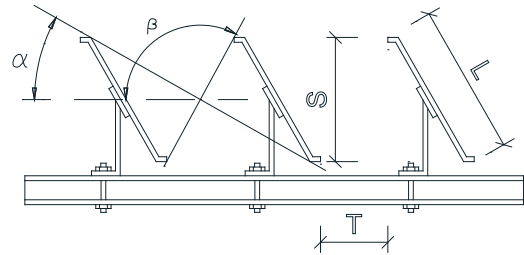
DETALLES ARQUITECTÓNICOS, CELOSÍA IMPLANTADO EN LAS FACHADAS.
